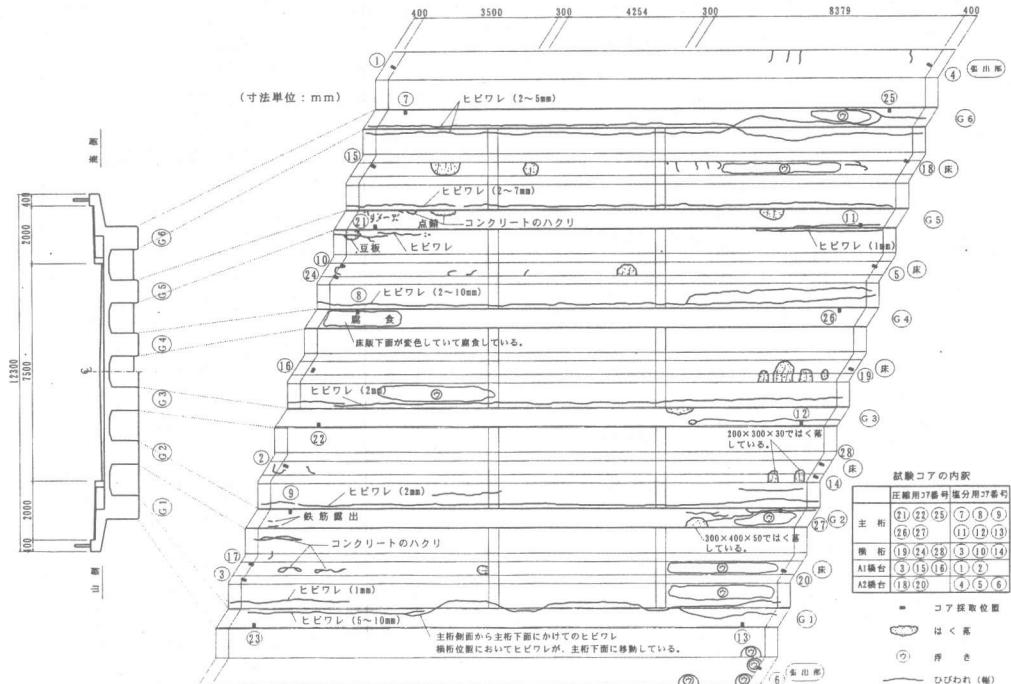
桃原橋のコンクリートひび割れ損傷図
